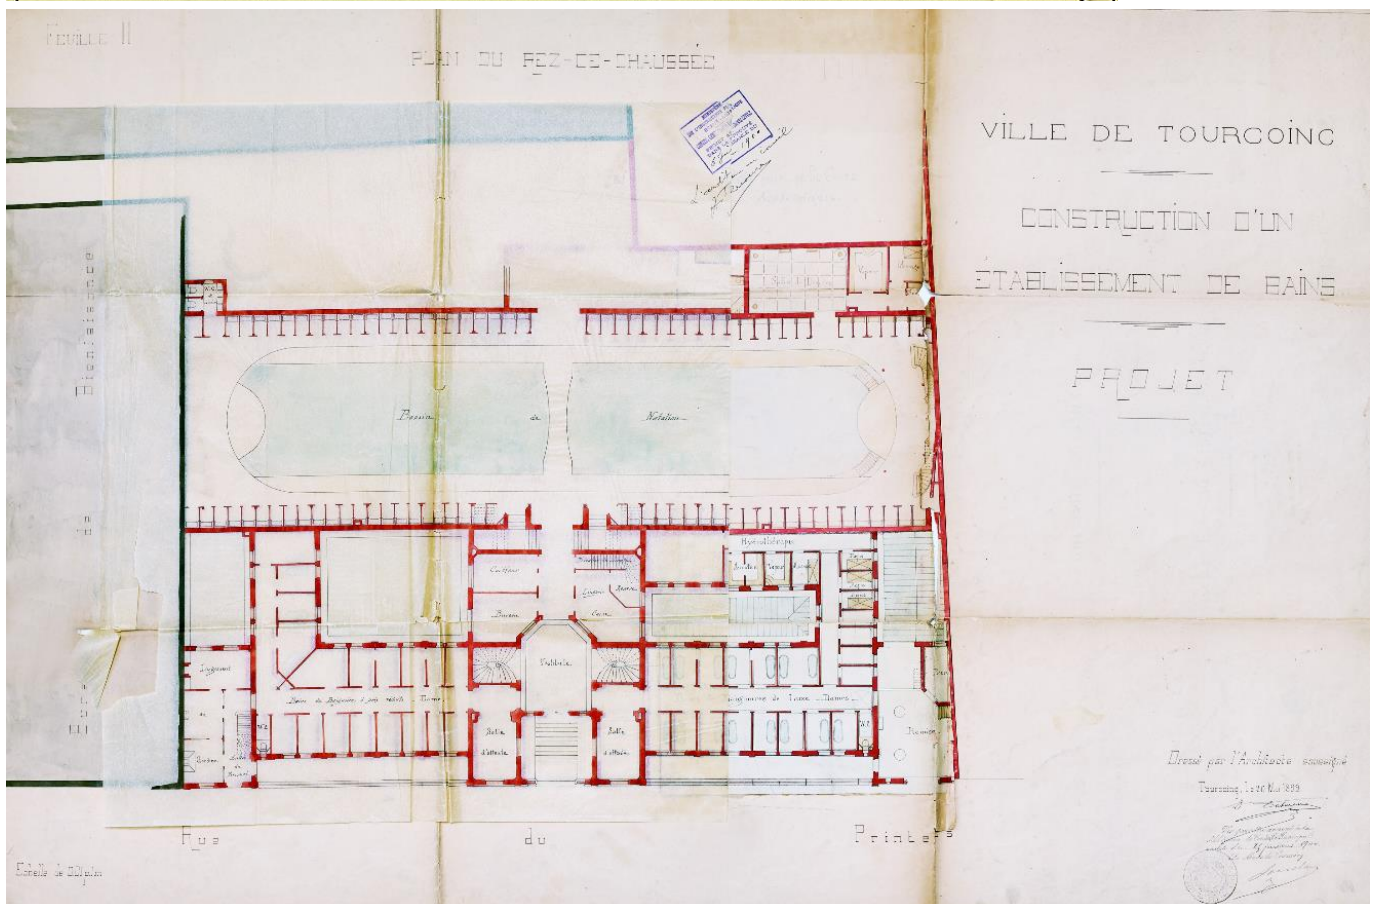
Ville de Tourcoing, construction d'un établissement de bains, Projet : plan du rez-de-chaussée, dessin à l'encre sur papier, par Désiré Dehaene, architecte, dressé le 20 mai 1899, validé par le conseil municipal le 25 janvier 1900. © AC de Tourcoing : M1F3. / Région Hauts-de-France - Inventaire général. Repro : Thibaut Pierre.
